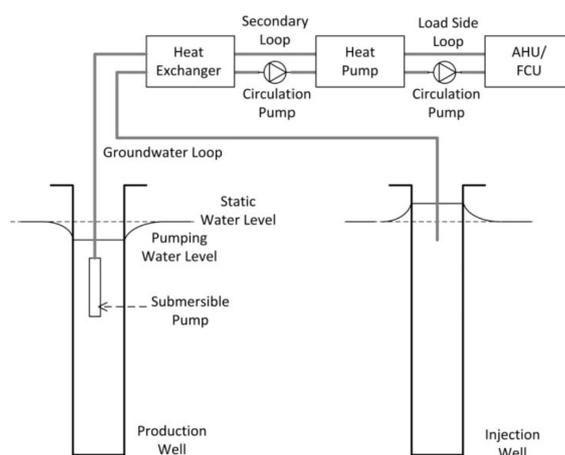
Layout di sistema per un GWHP indiretto [55]
